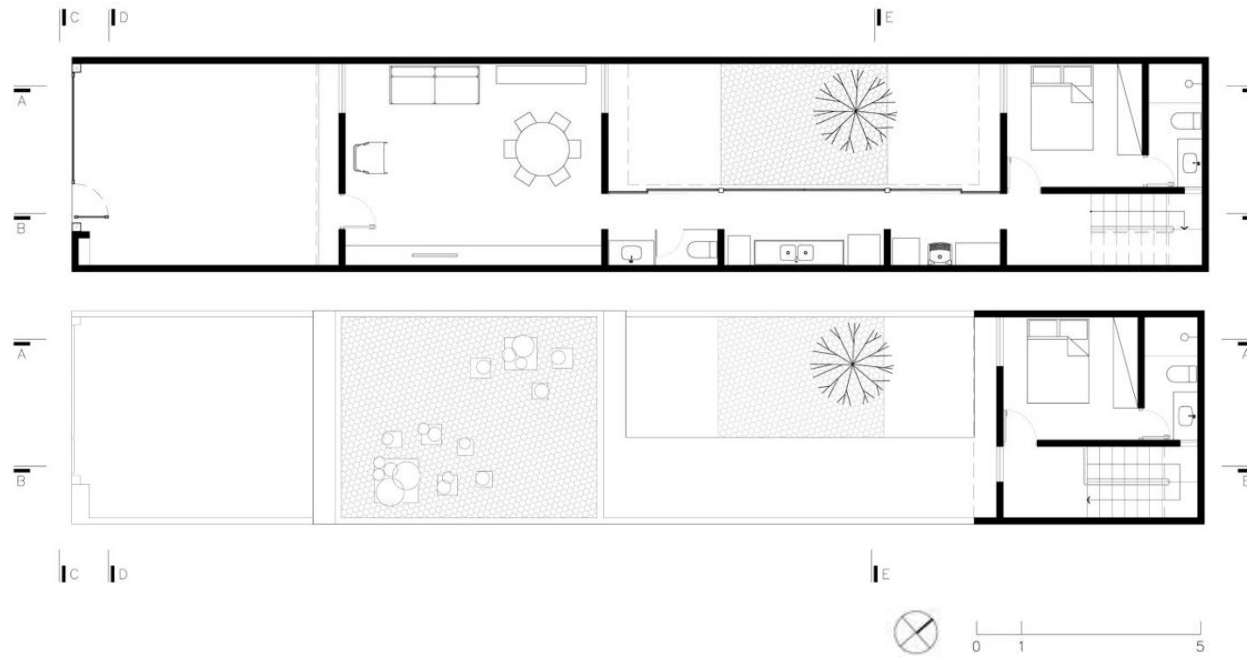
Casa en Vila Matilde - Planta baja y planta alta
